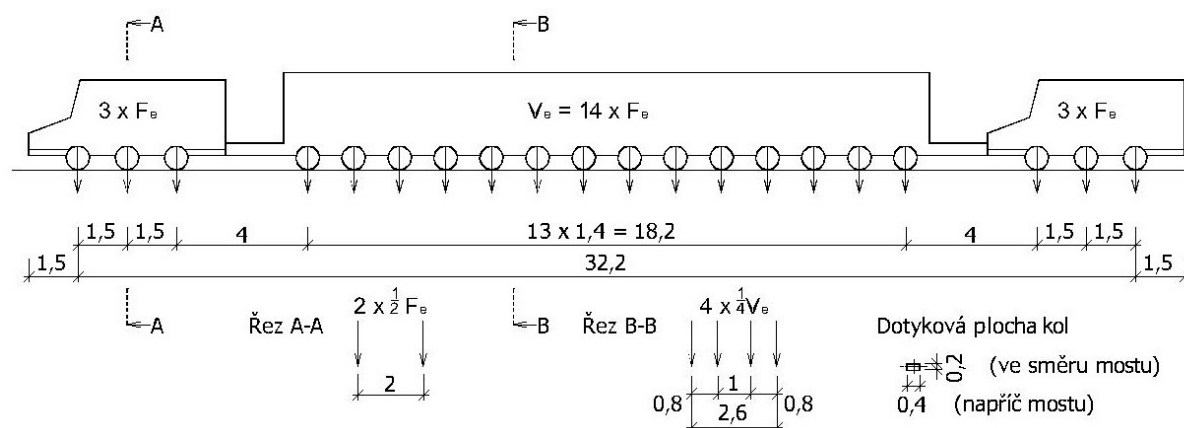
Zatěžovací schéma normální zatížitelnosti, seskupení II
